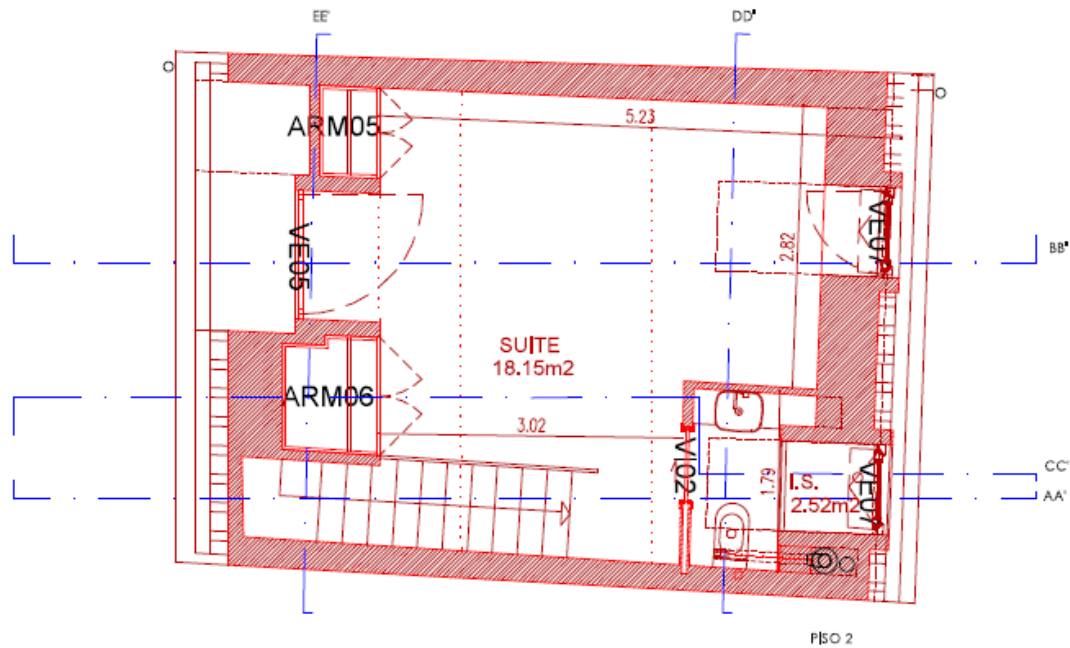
projeto de arquitetura piso 2 (Seleiro, Cruz, & Sandra, proposto planta dos pisos, 2017)
